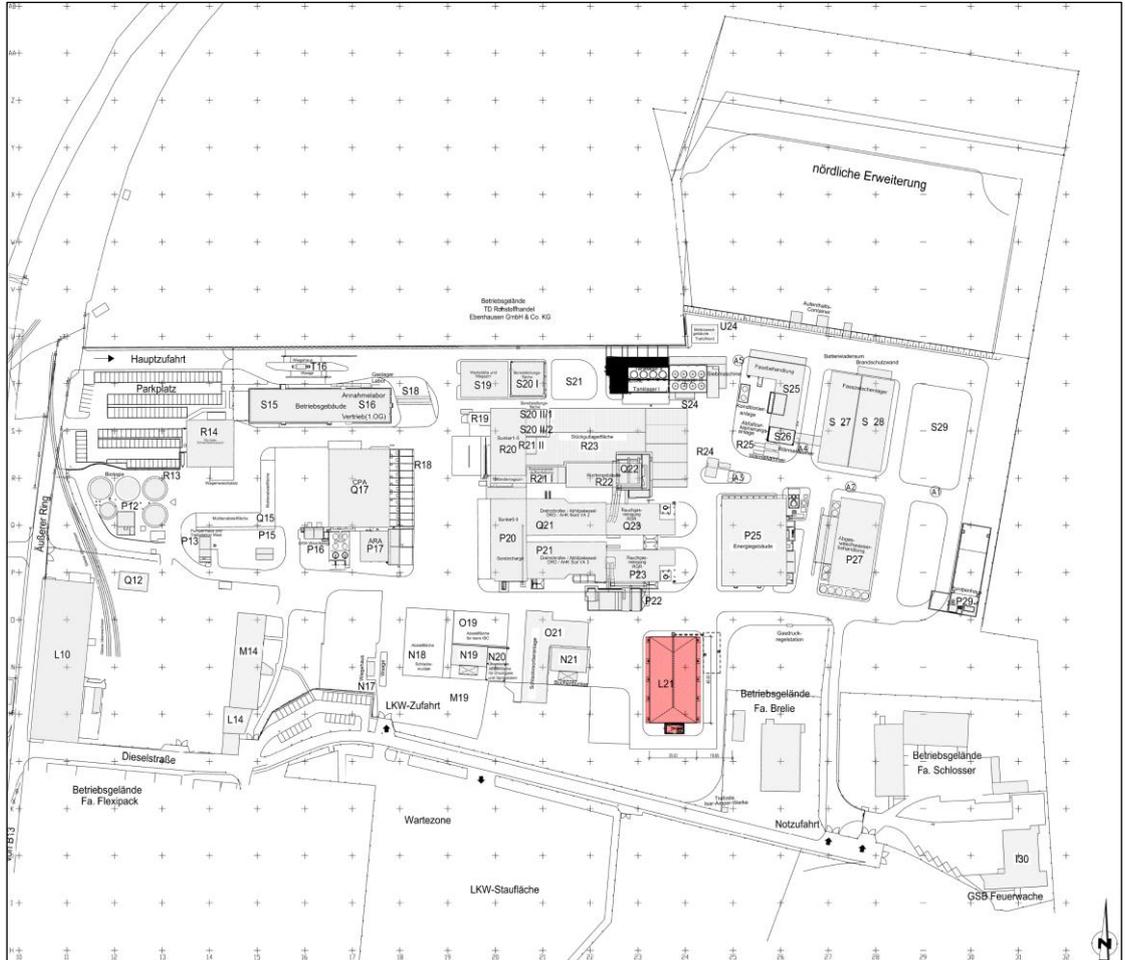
Lageplan der geplanten Stückgutabstellfläche L21 (Quelle: IA-Tech GmbH)
